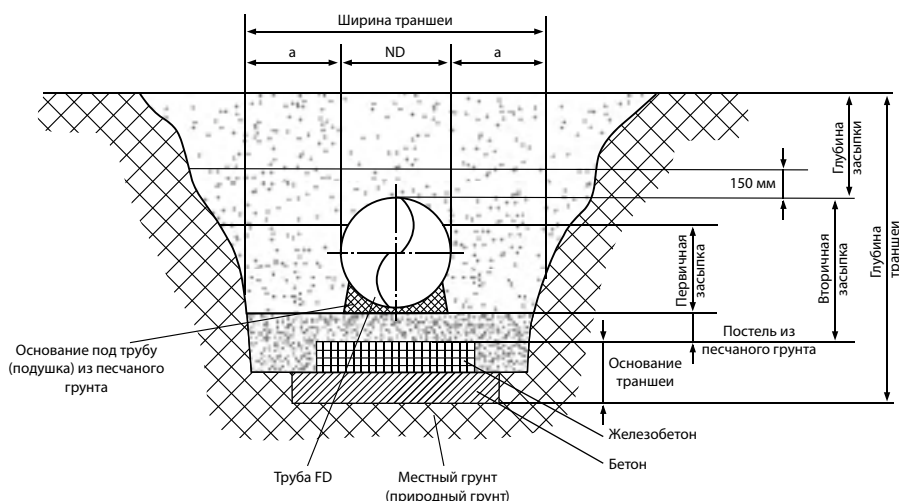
Схема укладки трубопровода на железобетонное основание
